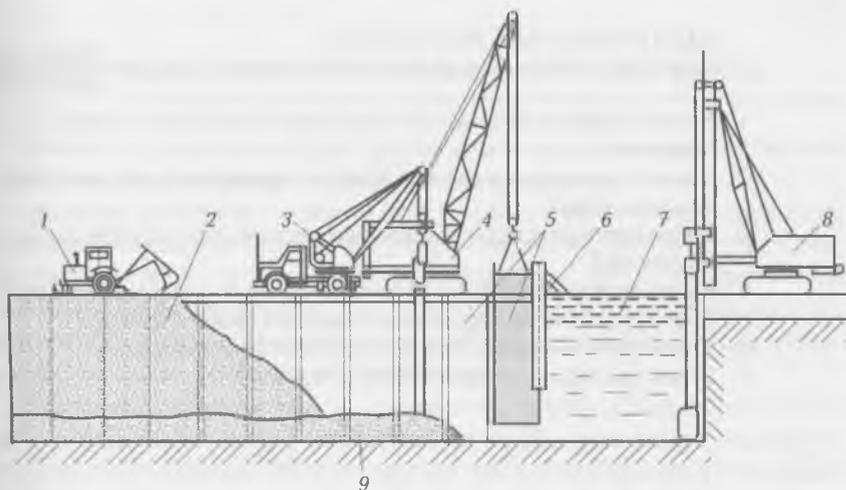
Возведение «стены в грунте» из сборных железобетонных плит:
